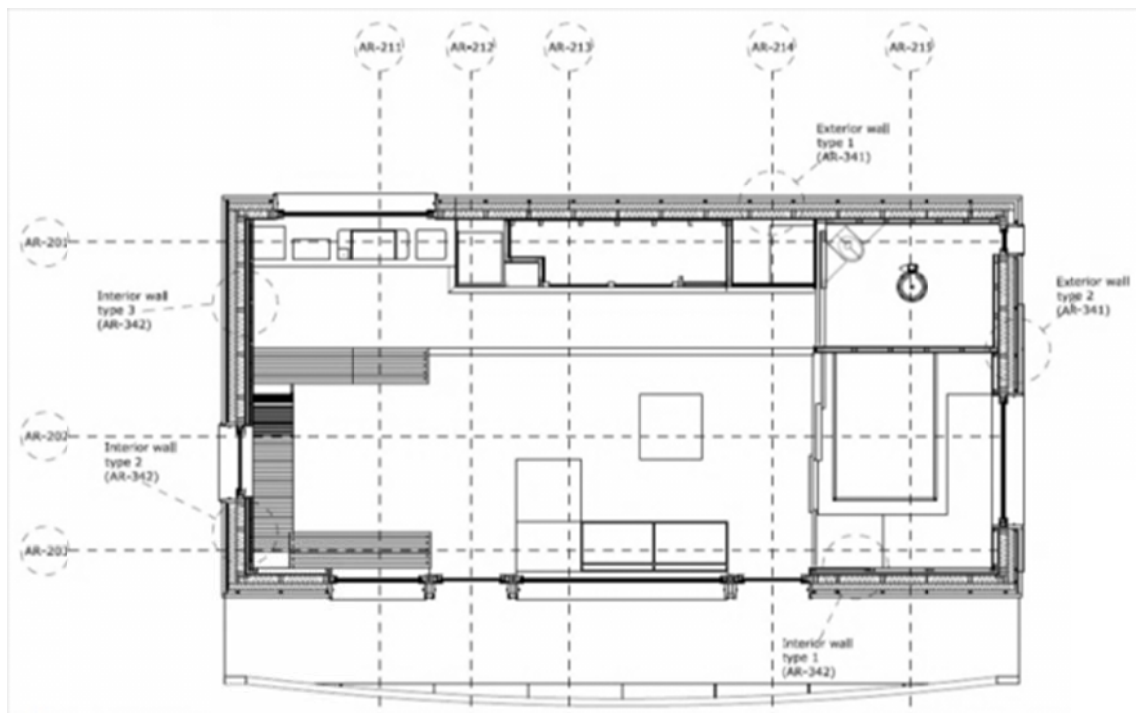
Plano planta distribución. Fuente: AMP_CD_2010-09-22
